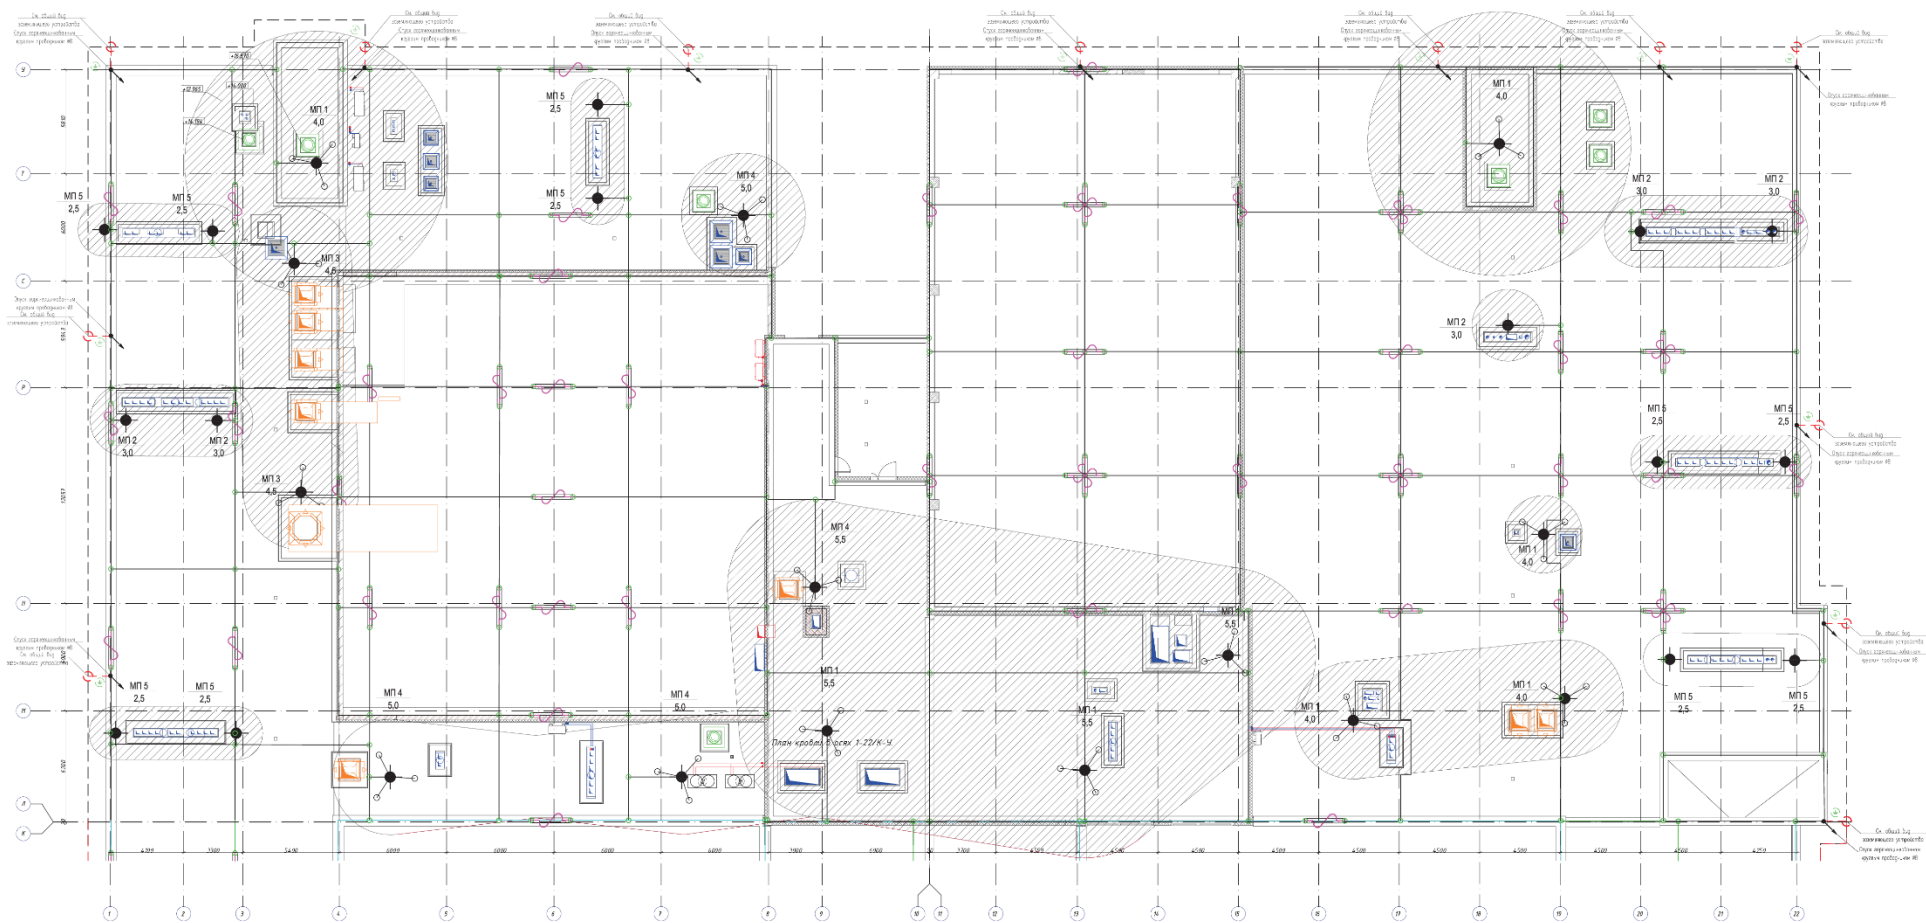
План кровли в осях 1-22/К-У. Молниезащита
